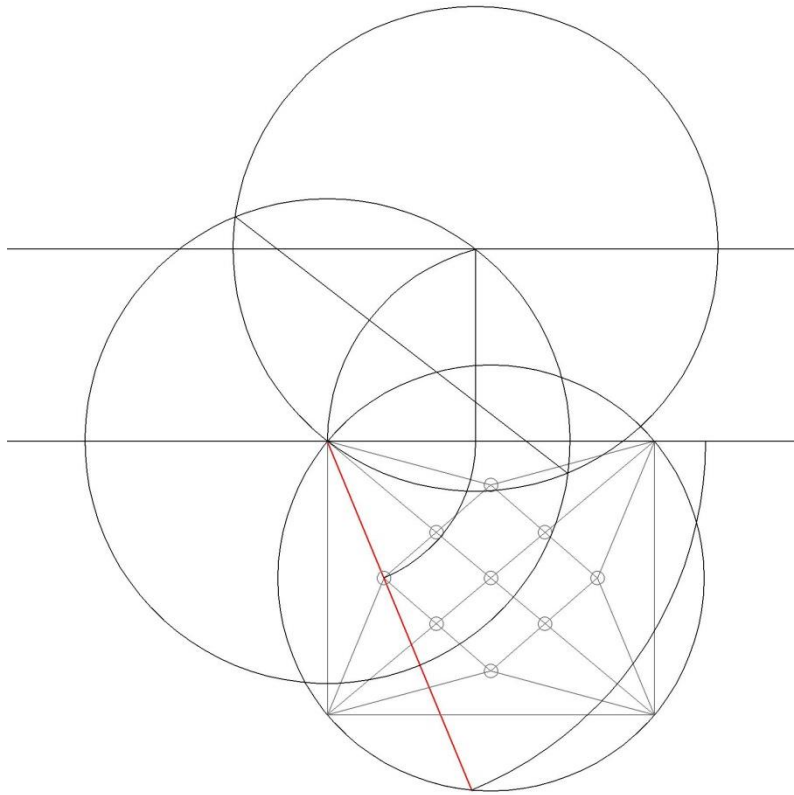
Primera hipótesis del trazado de los arcos de terceleté del lado menor de la planta rectangular.
